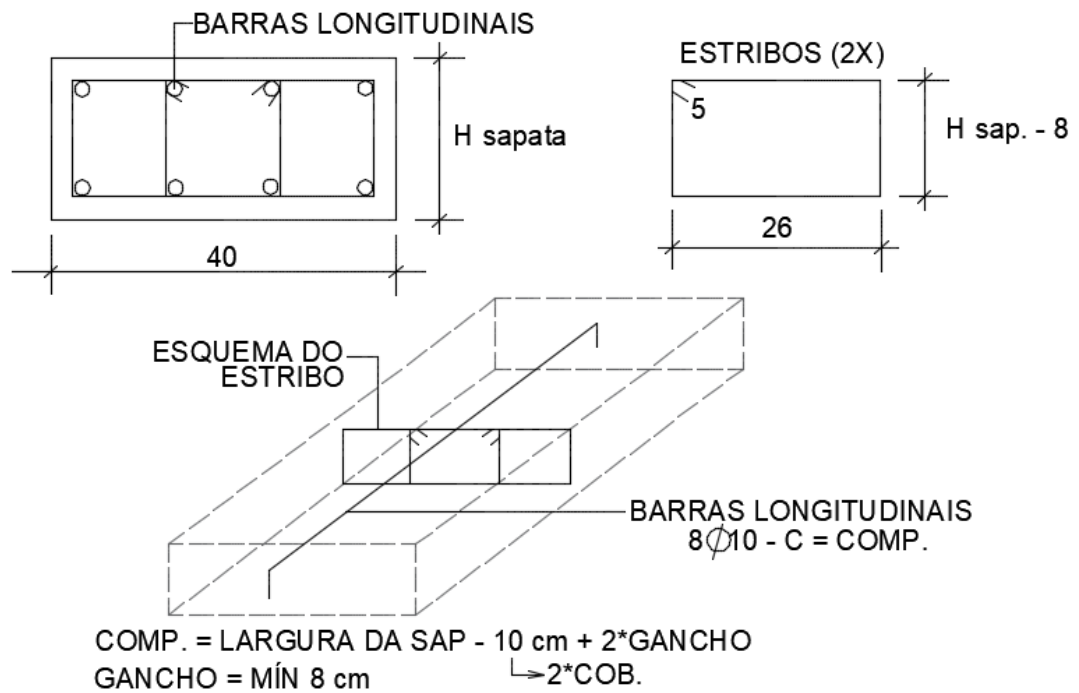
Vista em planta da ligação entre viga de equilíbrio e sapata de reforço (cm)
